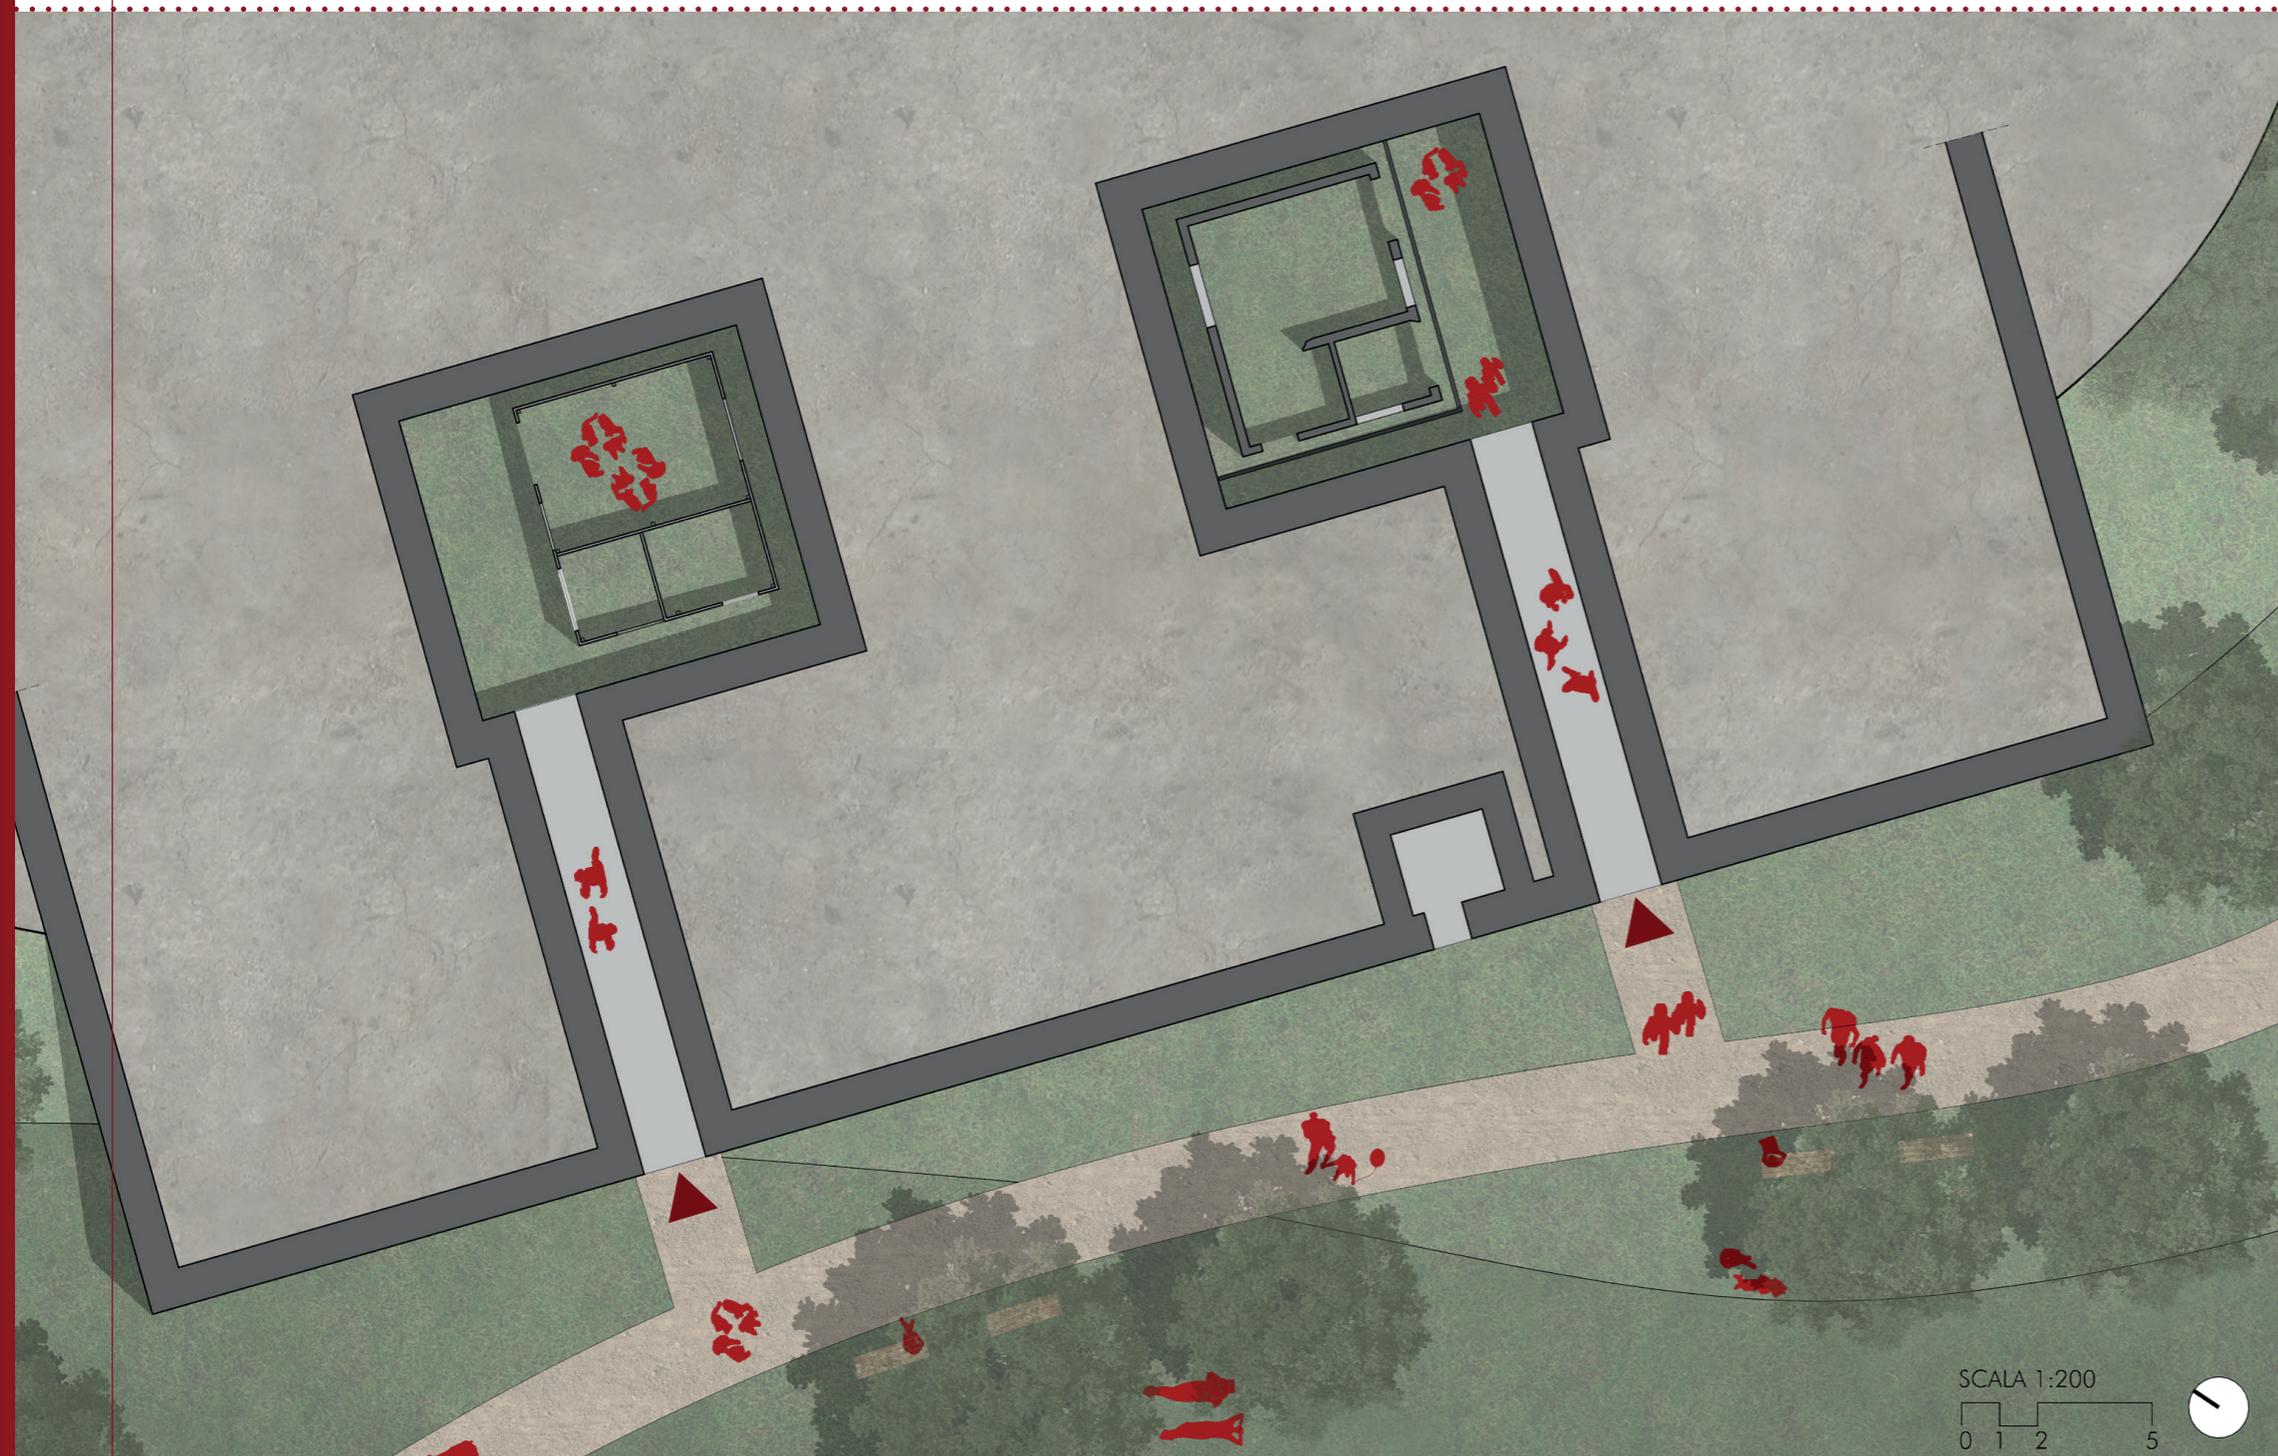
Pianta del piano terra delle "casematte", elaborazione delle autrici
